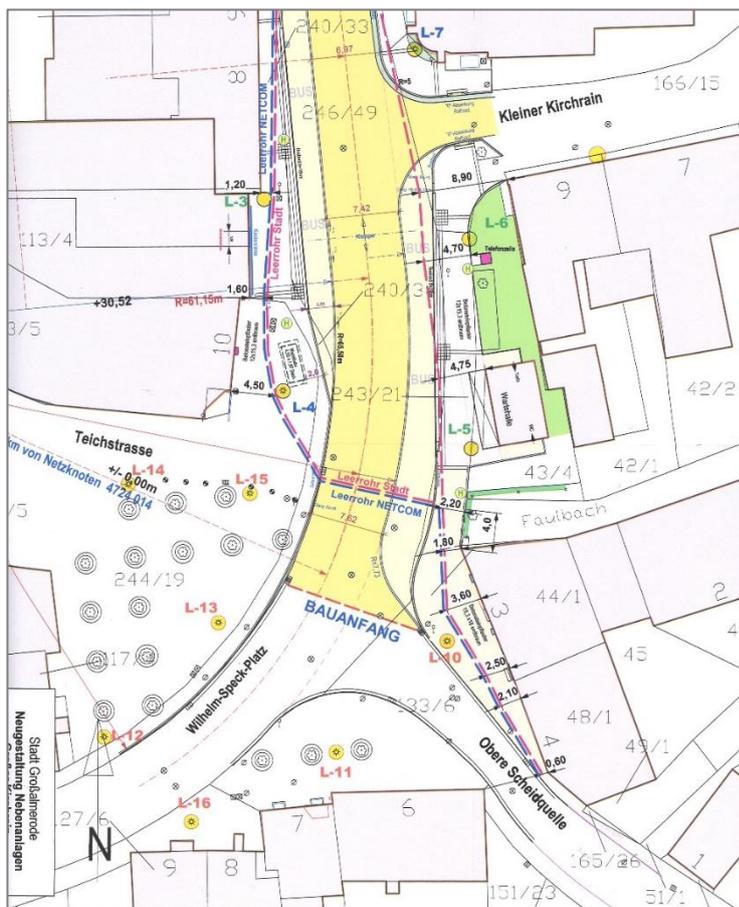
Lageplan Neugestaltung Nebenanlagen Großer Kirchrain – durchgeführte Stadtumbaumaßnahme (Büro für Stadt- und Landschaftsplanung 2012)
